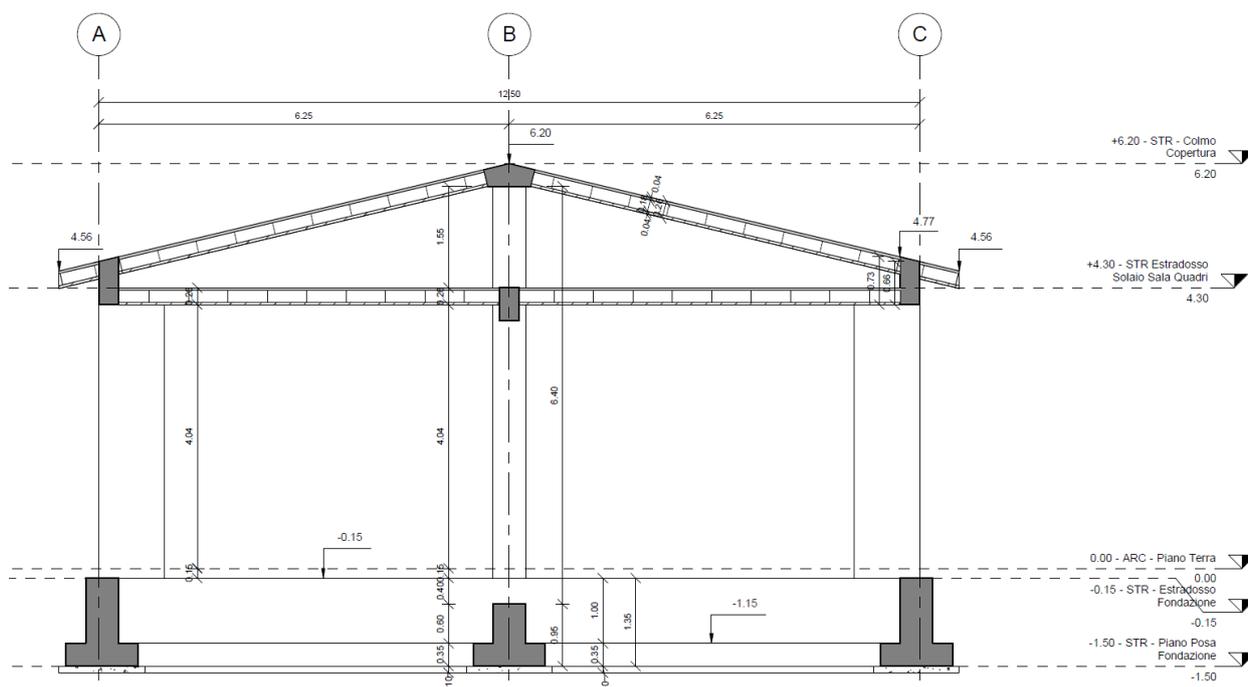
SSE Pieve Emanuele - Sezione strutturale
